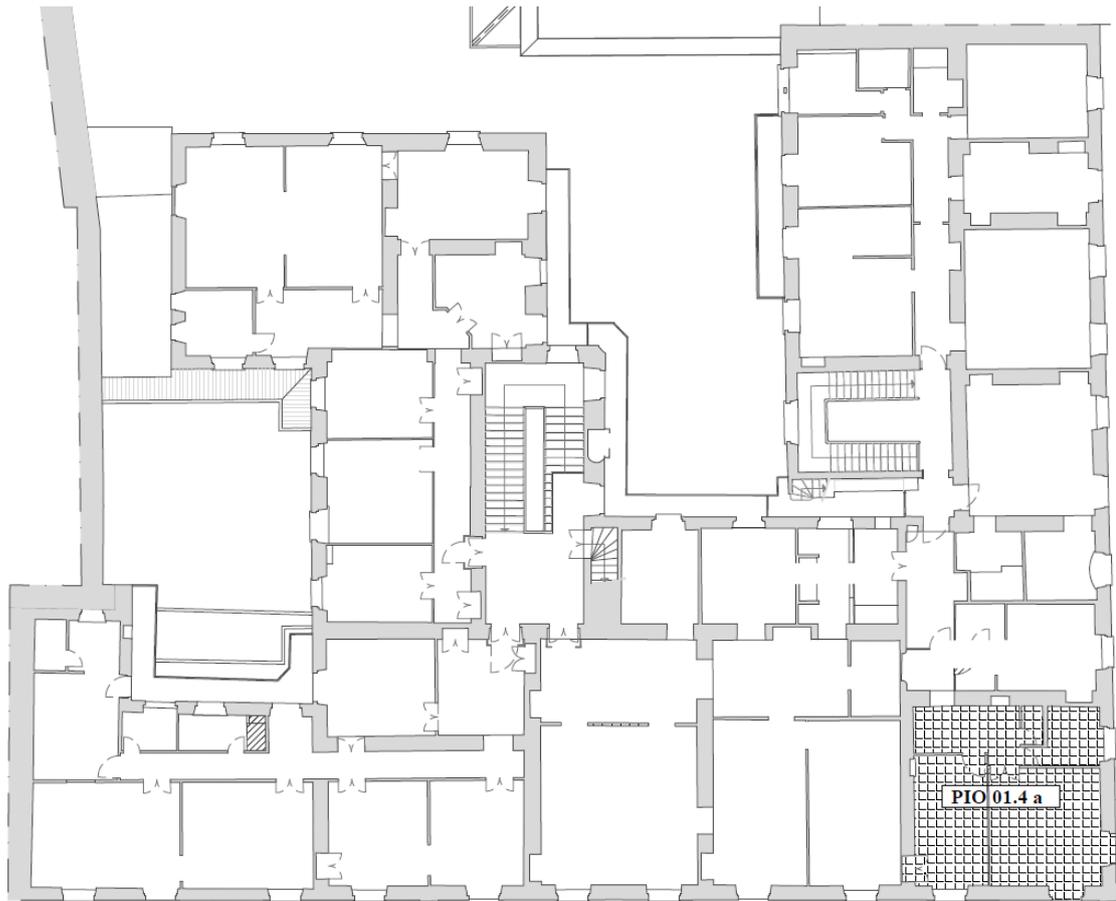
Stralcio della pianta del quarto piano con individuazione solaio considerato
